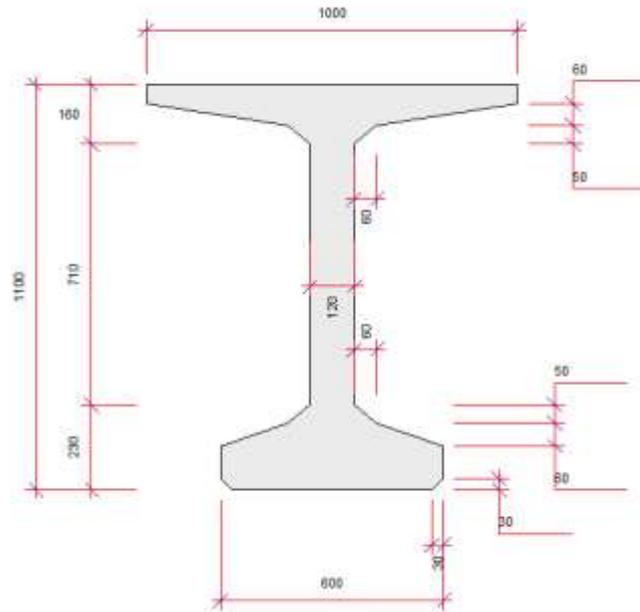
Sección de las vigas. Cotas en mm. Fuente: El. prop.
